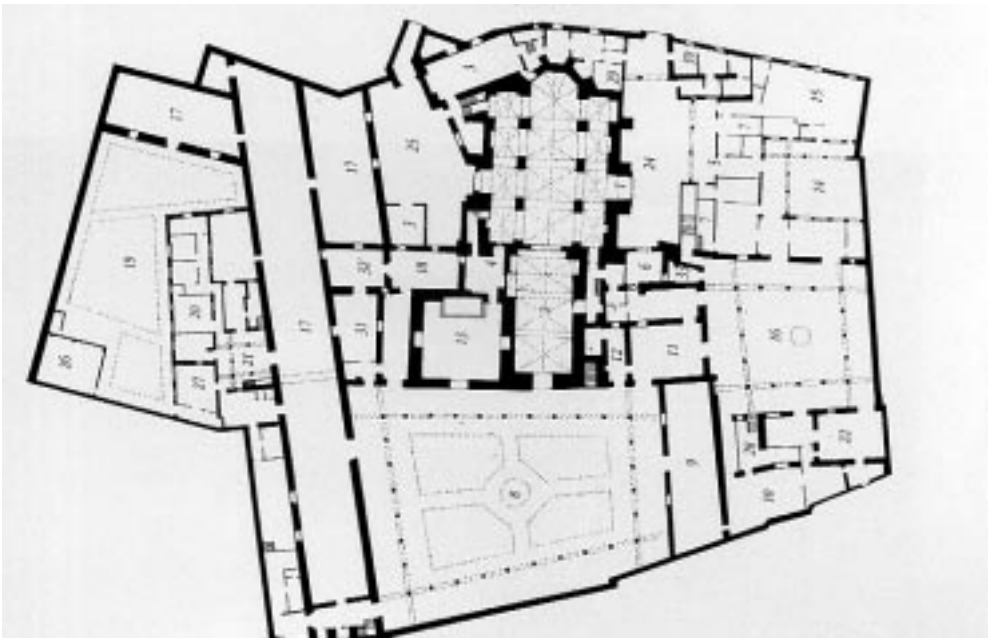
Sevilla. Monasterio de Santa Inés. Planta.
